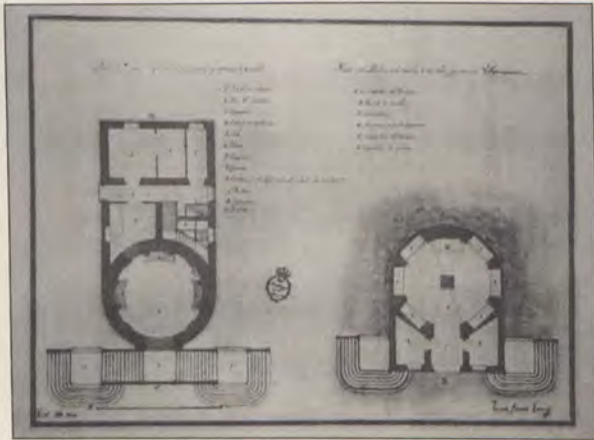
Plantas de la Casa Sepulcro del vía crucis y habitación del Ermitorio. Planta del Panteón de la familia de los nobles Guijarros en Villafranqueza. Vicente Ramón García. 1804 Academia de San Fernando A- 4865
